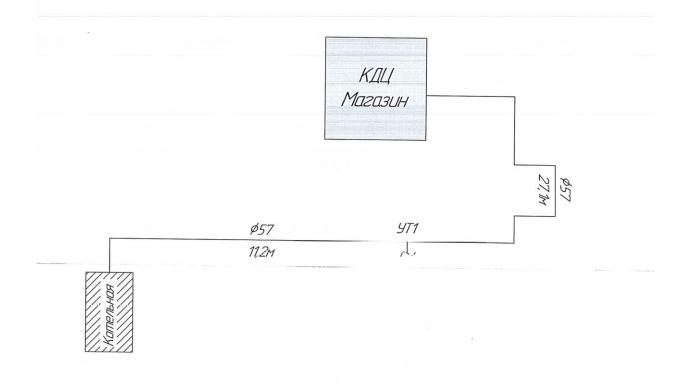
Схема тепловых сетей котельной №6-7
